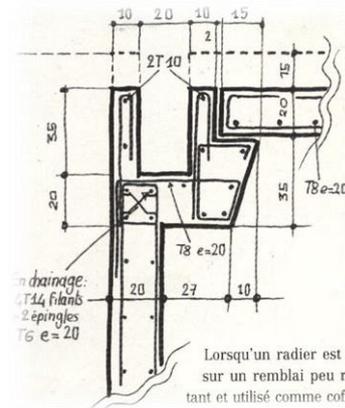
Détail du ferrailage de l'appui d'une plage sur une chéneau de piscine à débordement
